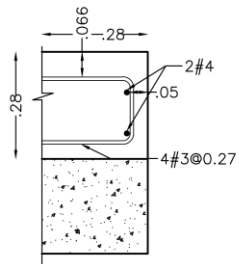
Detalle de Viga Superior (FS63 y FS64)
